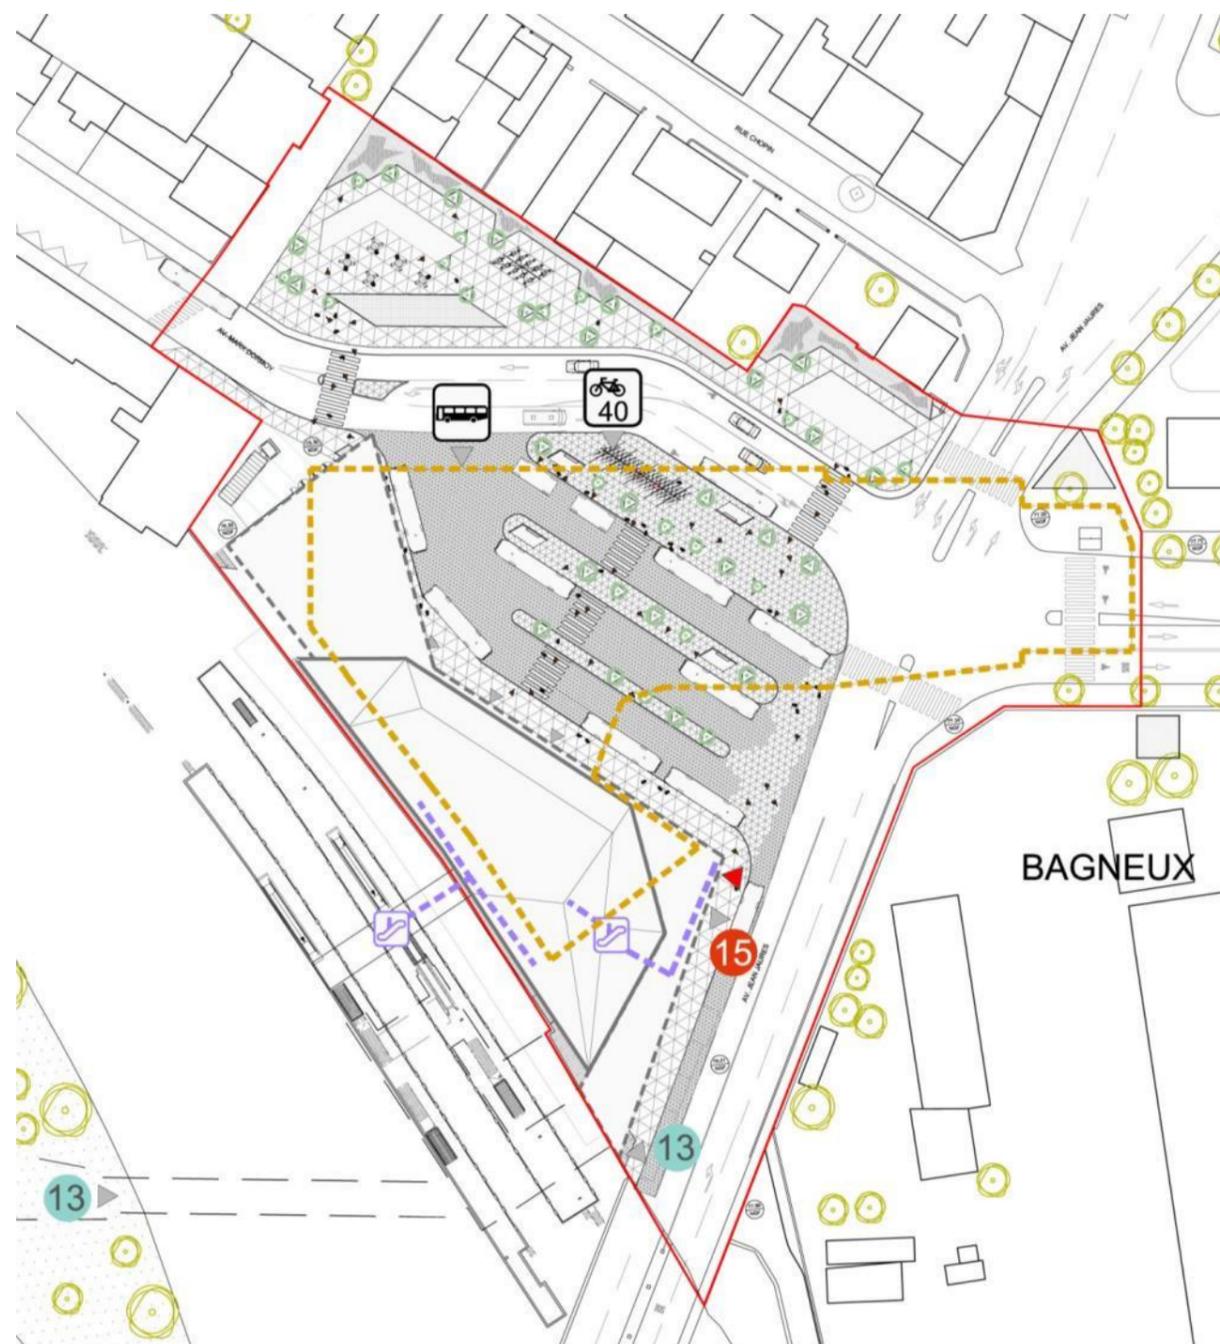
Gare de Châtillon Montrouge – plan d’implantation
